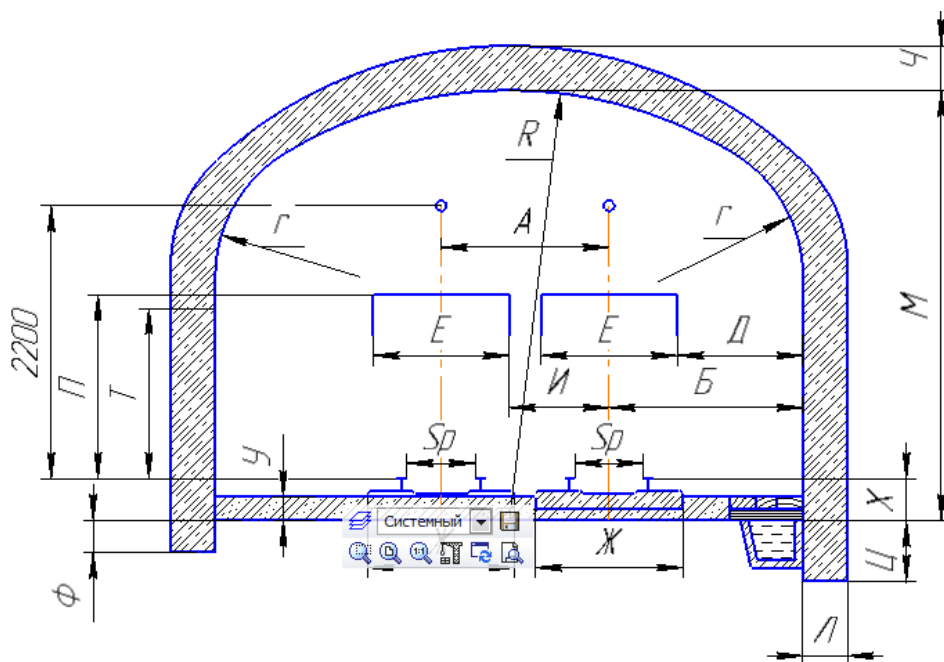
Поперечное сечение двухпутевой горизонтальной выработки с бетонной монолитной крепью
